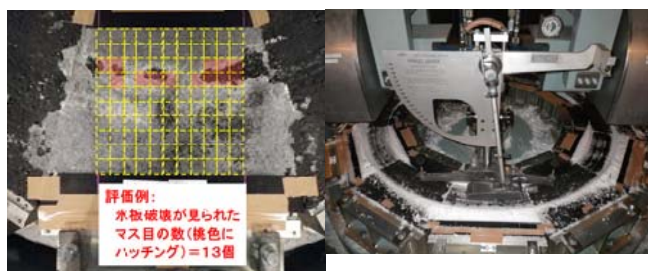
氷板破壊率算出例 写真-18 BPN測定状況
